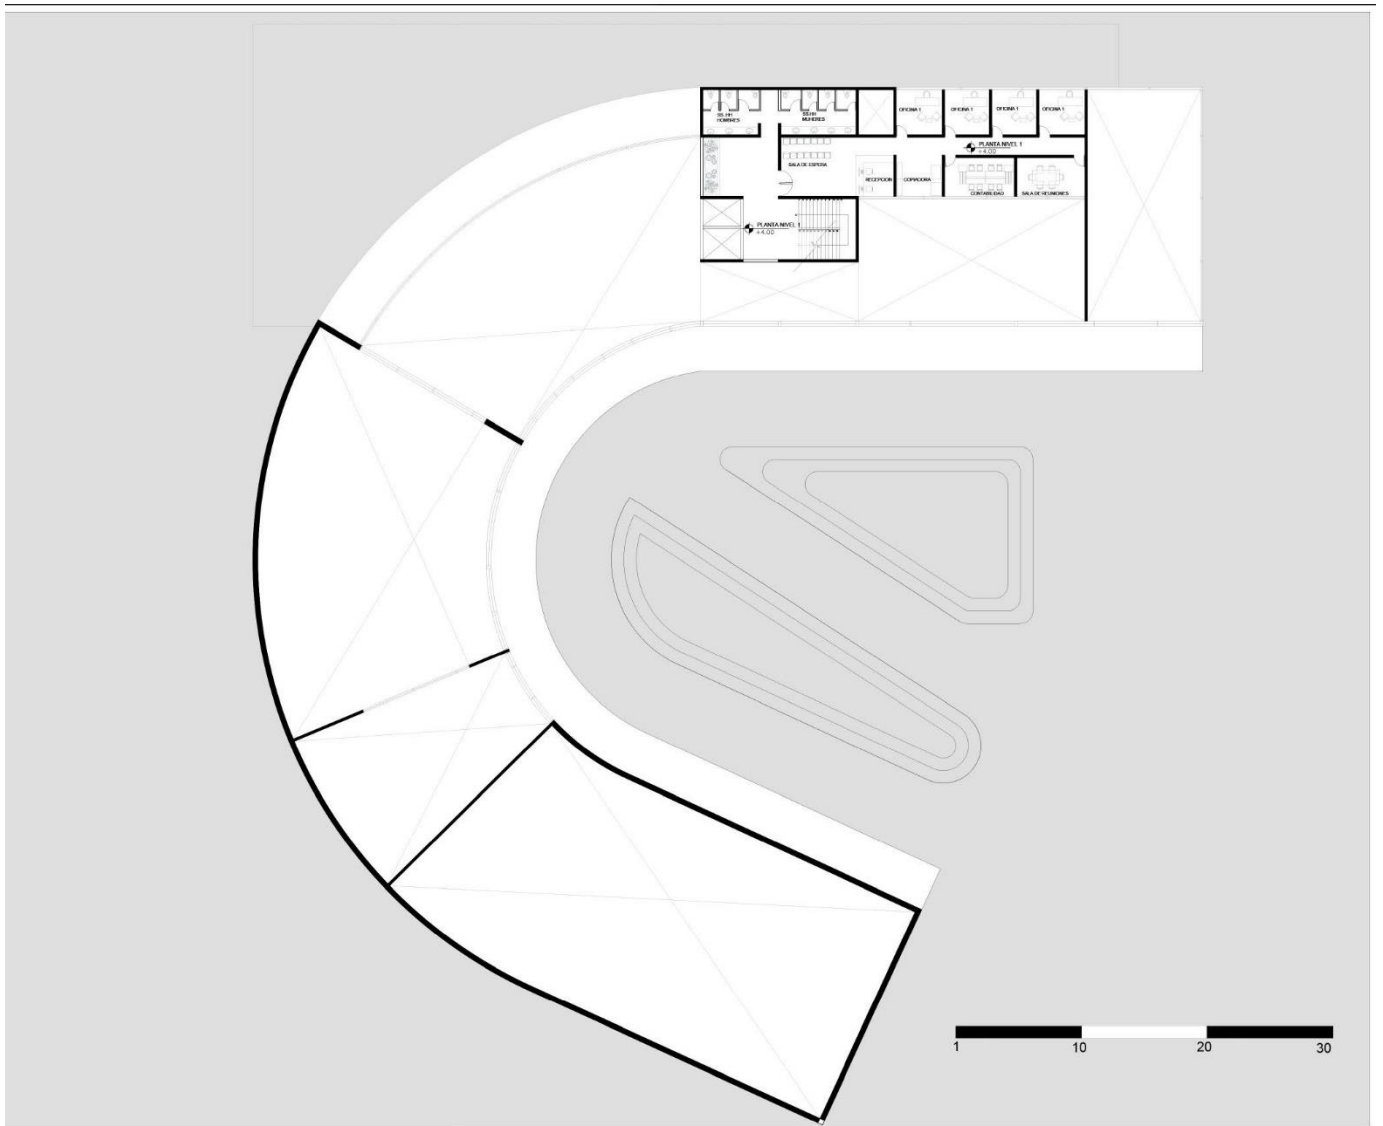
PLANTA NIVEL 1. Elaboración propia..
